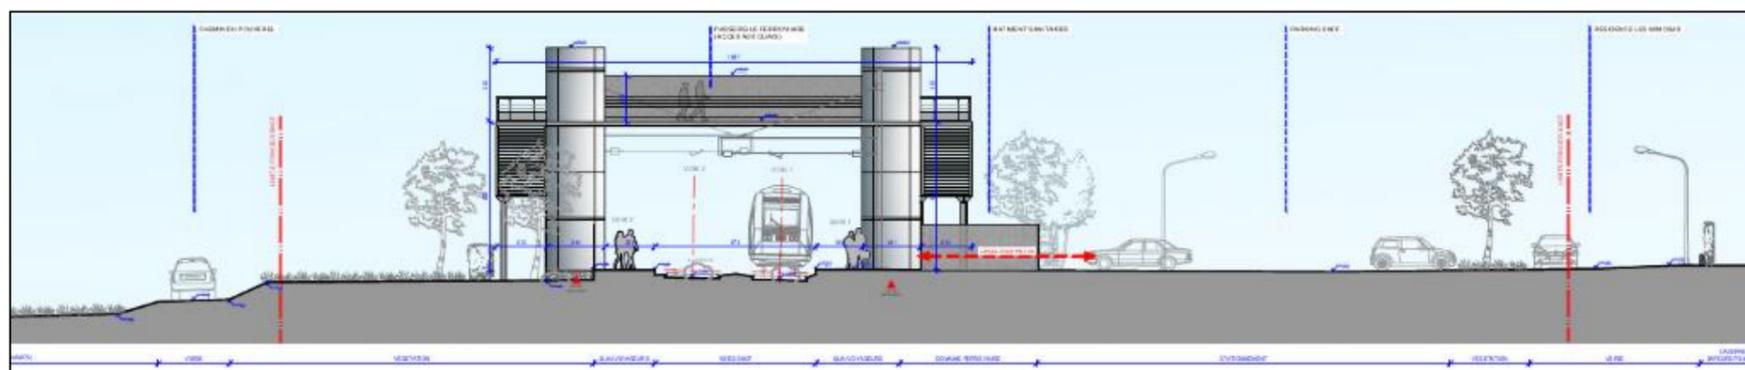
Cuers - coupe sur site (AREP, 2021)
